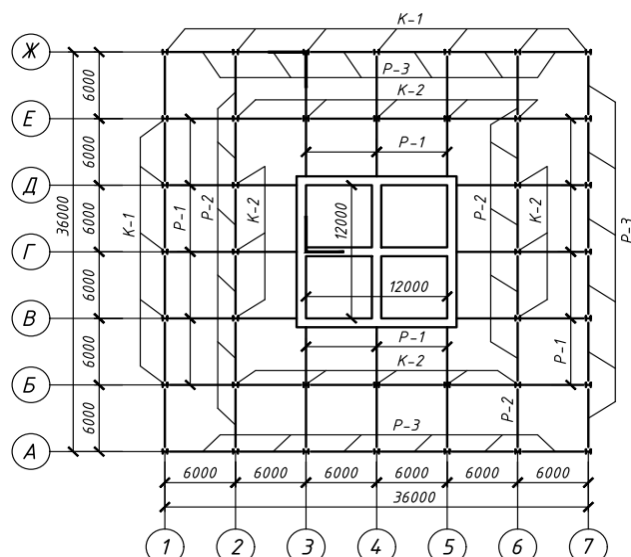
Схема расположения несущих конструкций высотного здания ствольно-каркасной конструктивной схемы: K-1, K-2 – колонны каркаса; P-1, P-2, P-3 – ригели каркаса
